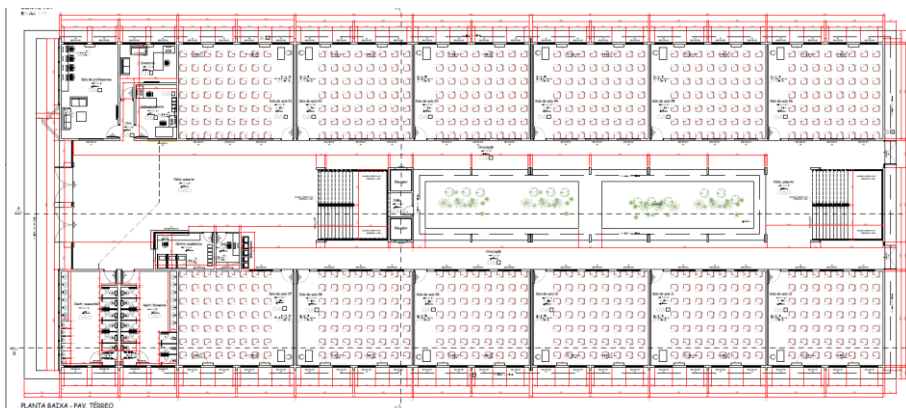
Projeto executivo, pavimento térreo – Bloco VI.
